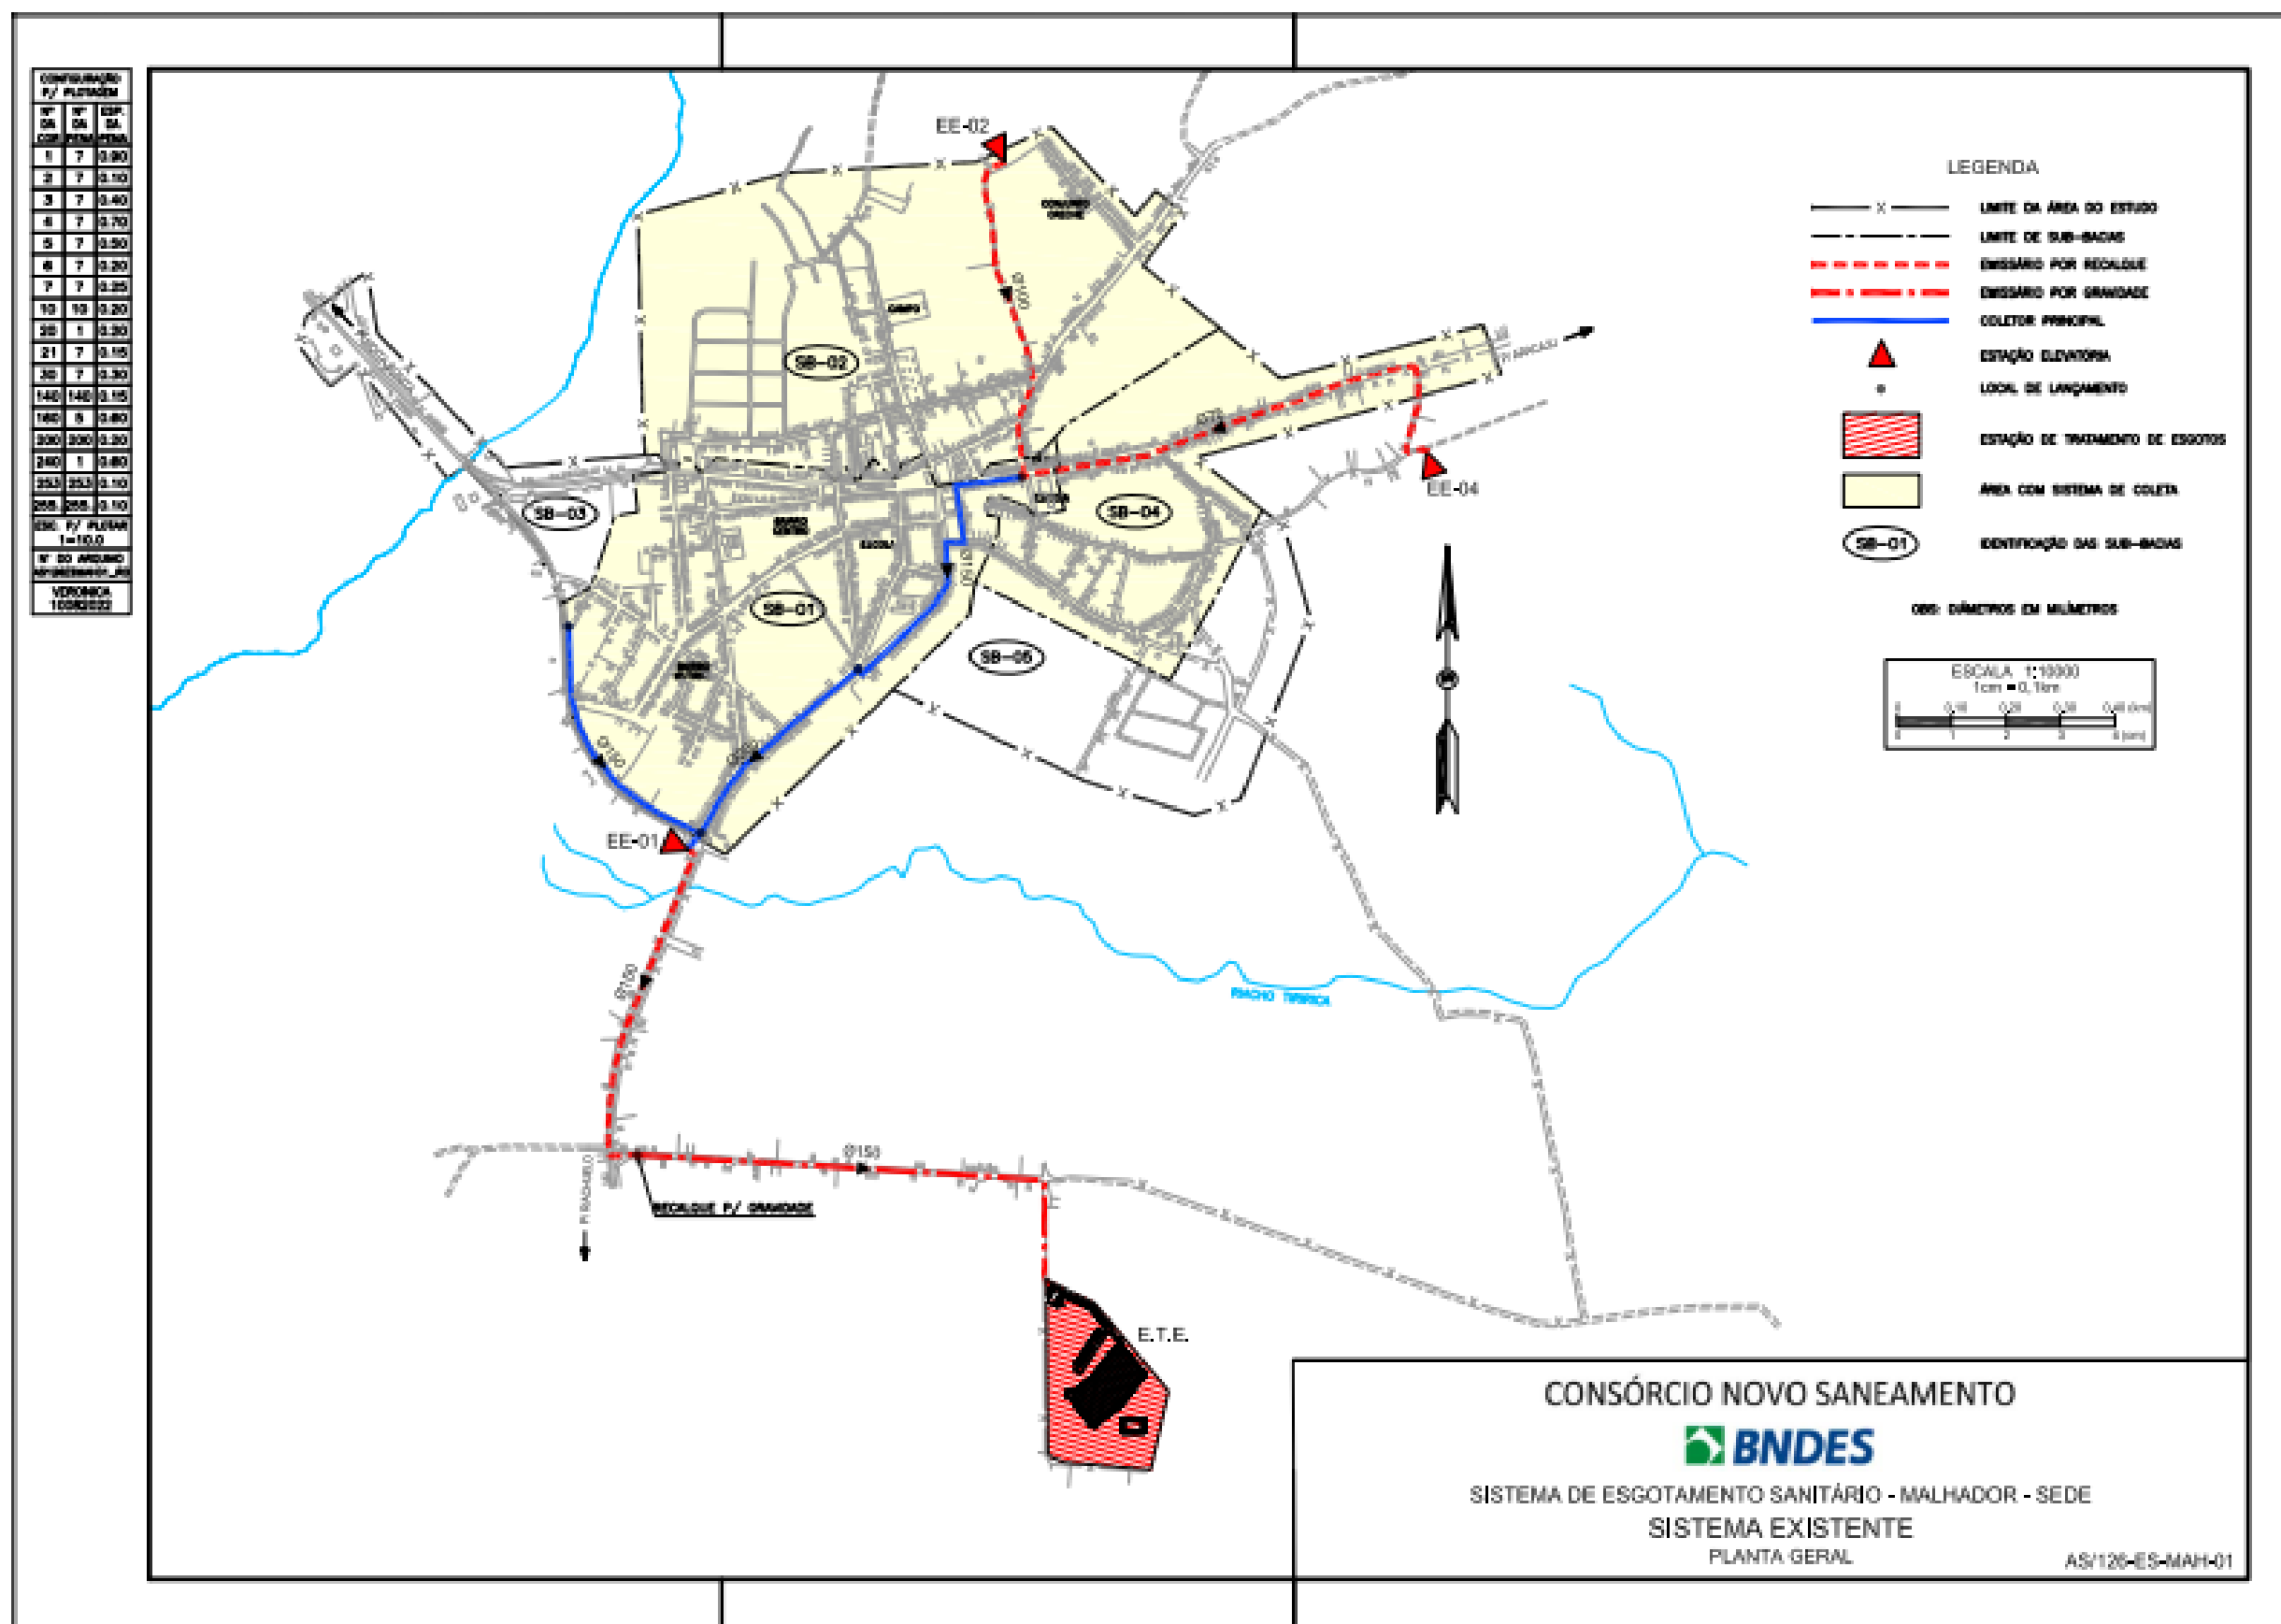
Planta do Sistema de Esgotamento Sanitário – MALHADOR
